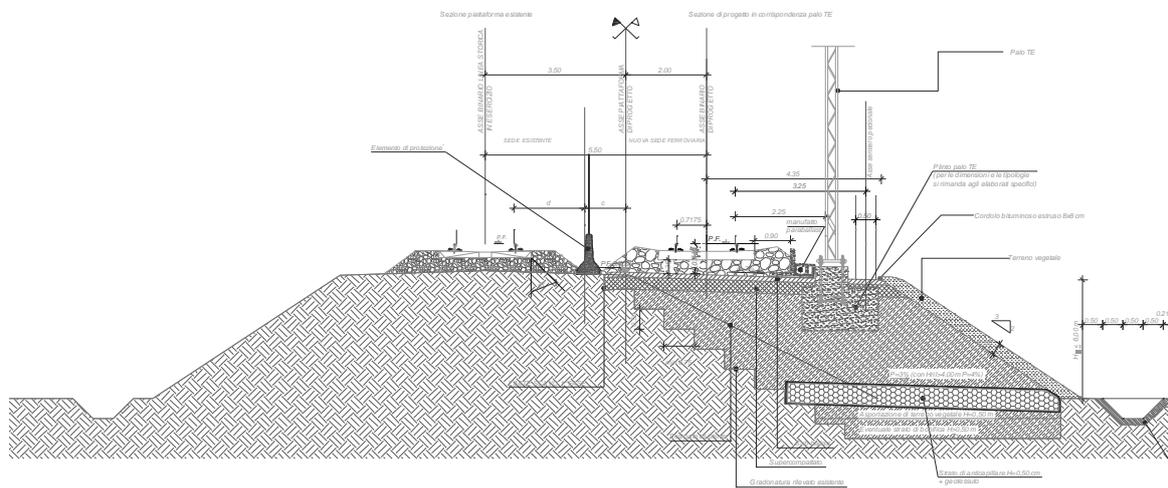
Fasi realizzative: sezione tipo in affiancamento in rilevato – Fase 1
